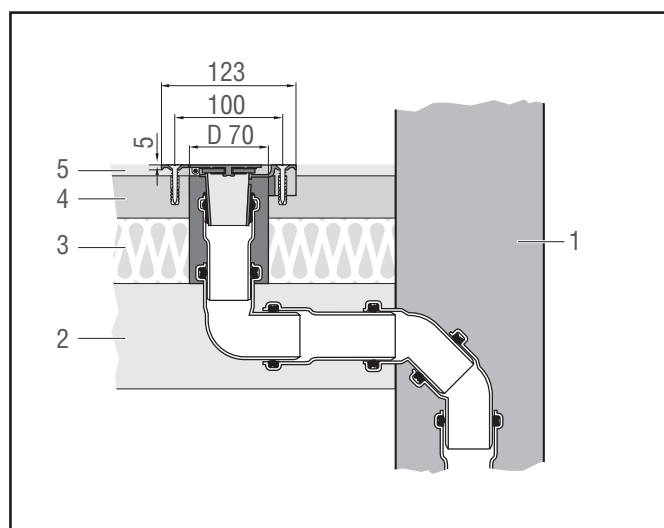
Схема монтажа при закладке труб в бетон.
